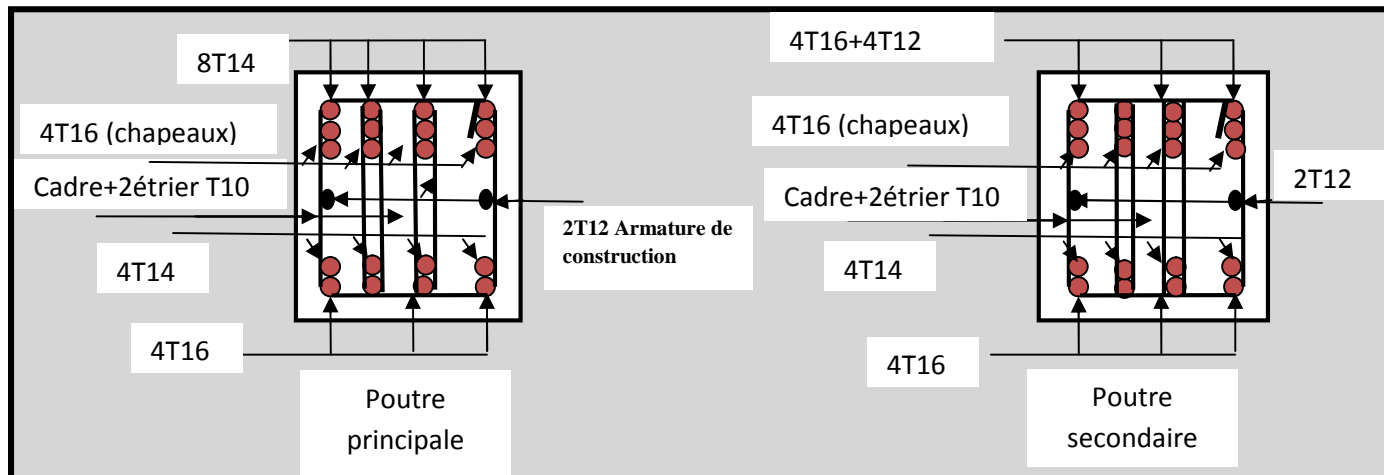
Schéma de ferrailage des poutres principales et secondaires du sous-sol et RDC (1et2)
